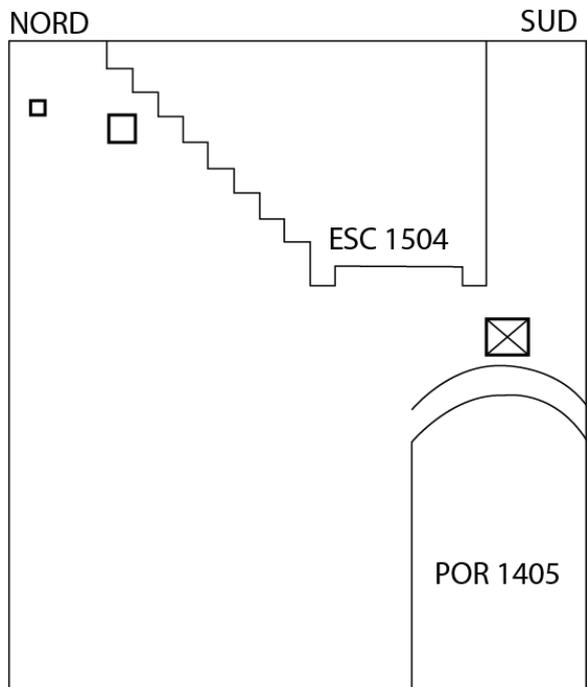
Mur sud (1302) de la pièce sud-est au rez-de-chaussée (PCE 13), croquis.
